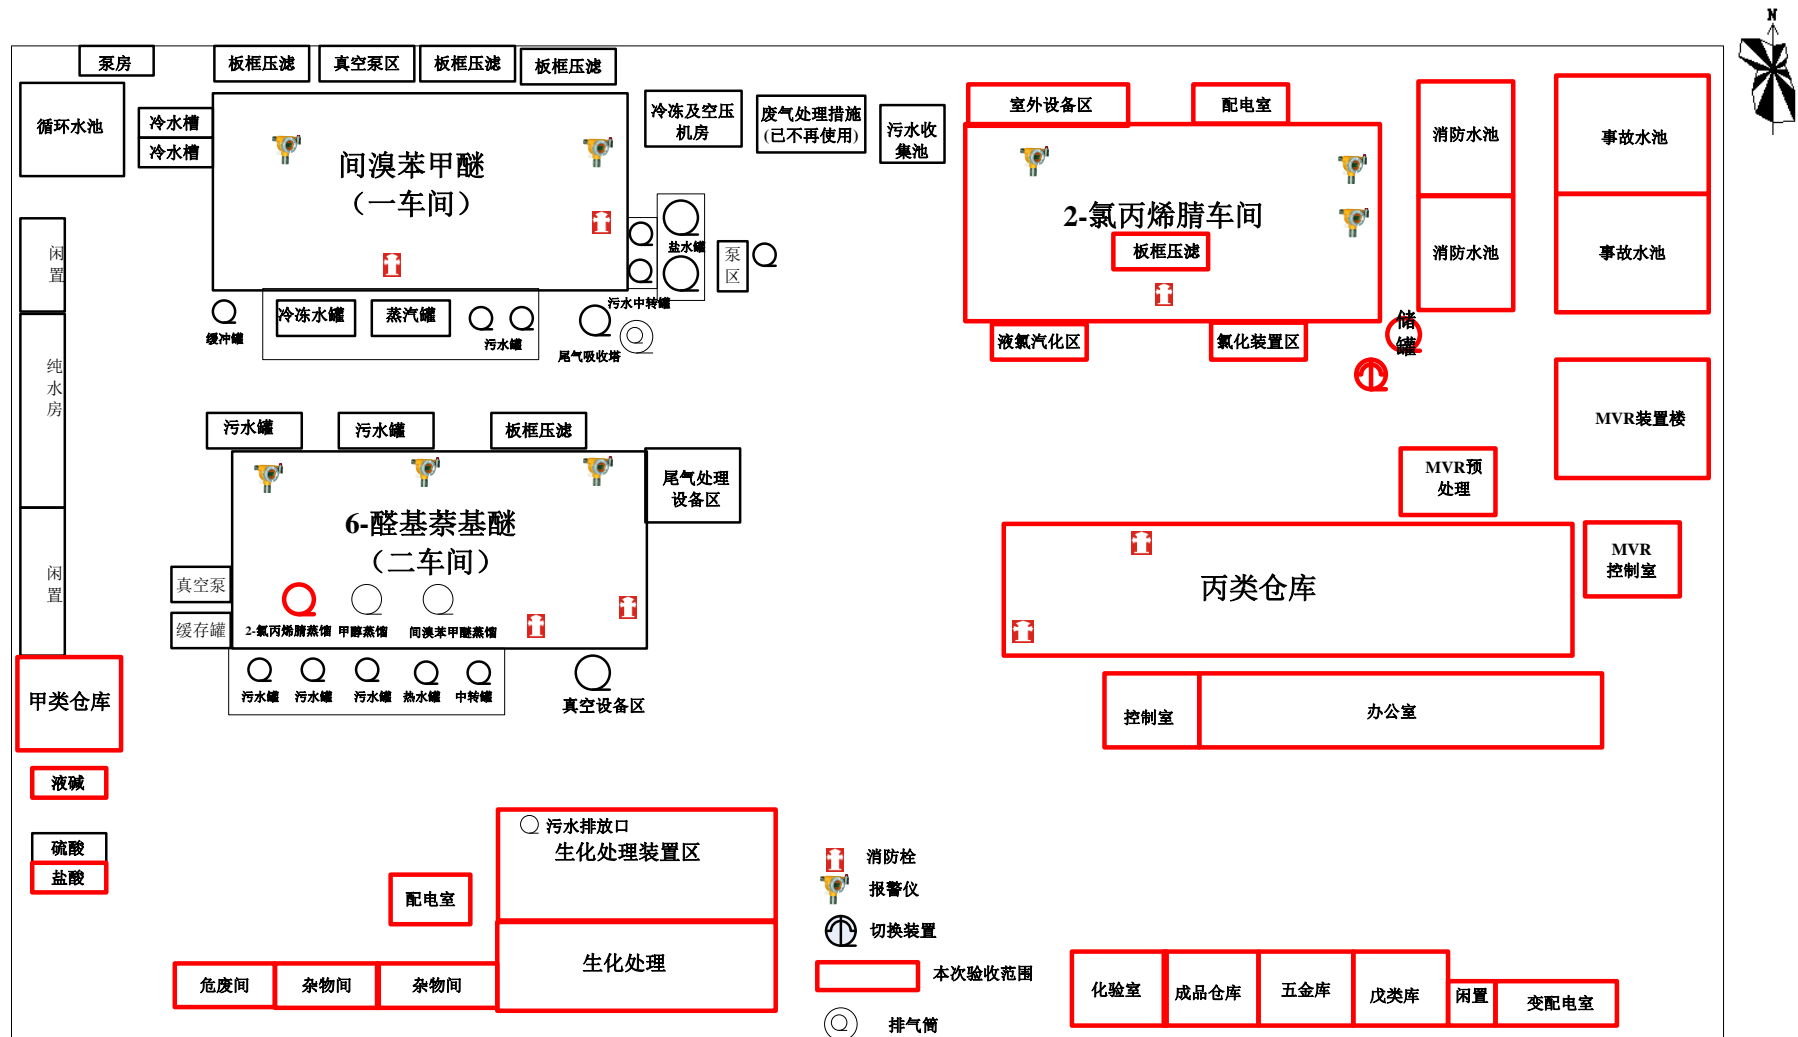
厂区平面布置图（红色框内为本次验收范围）
